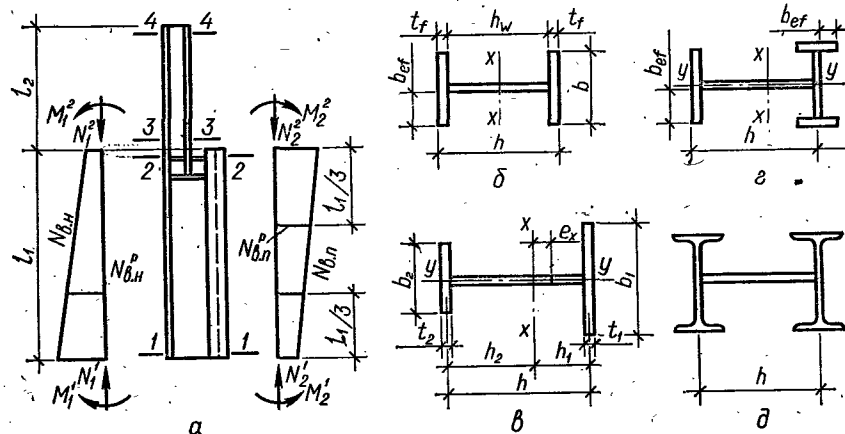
К расчету сплошностенчатой внецентренно-сжатой колонны: а — схемы и эпюры продольных усилий в наружной $N_{в.н}$ и подкрановой $N_{п.к}$ ветвях; б, д — варианты симметричных сечений; в, е — то же, несимметричных.
